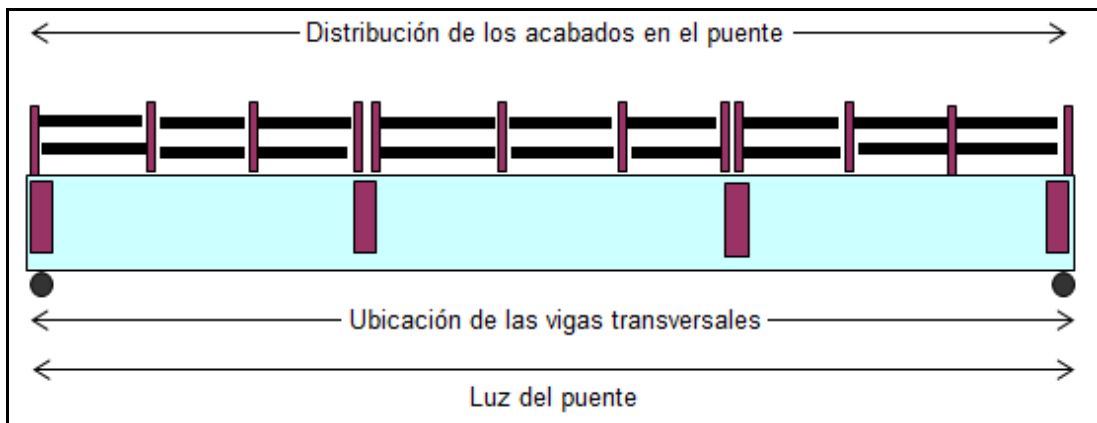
Ubicación de diafragma en el centro. Puente Piedra Fina
